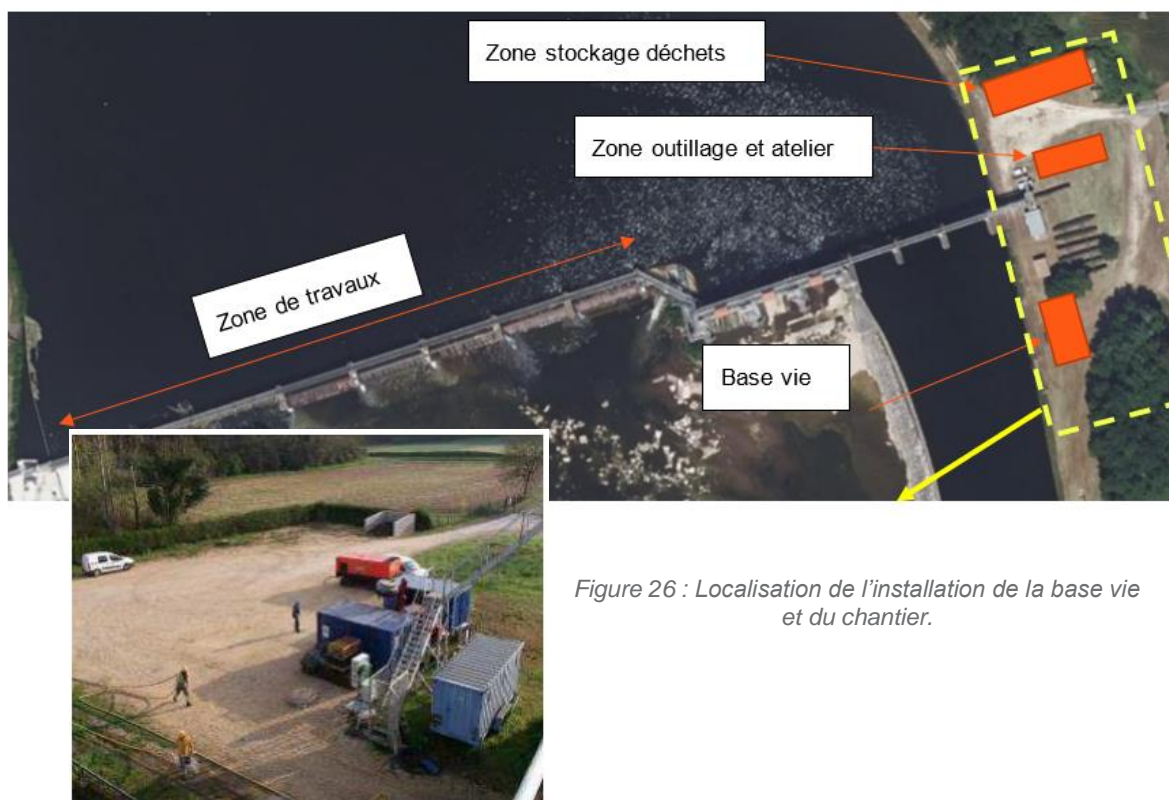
Localisation de l'installation de la base vie et du chantier.
